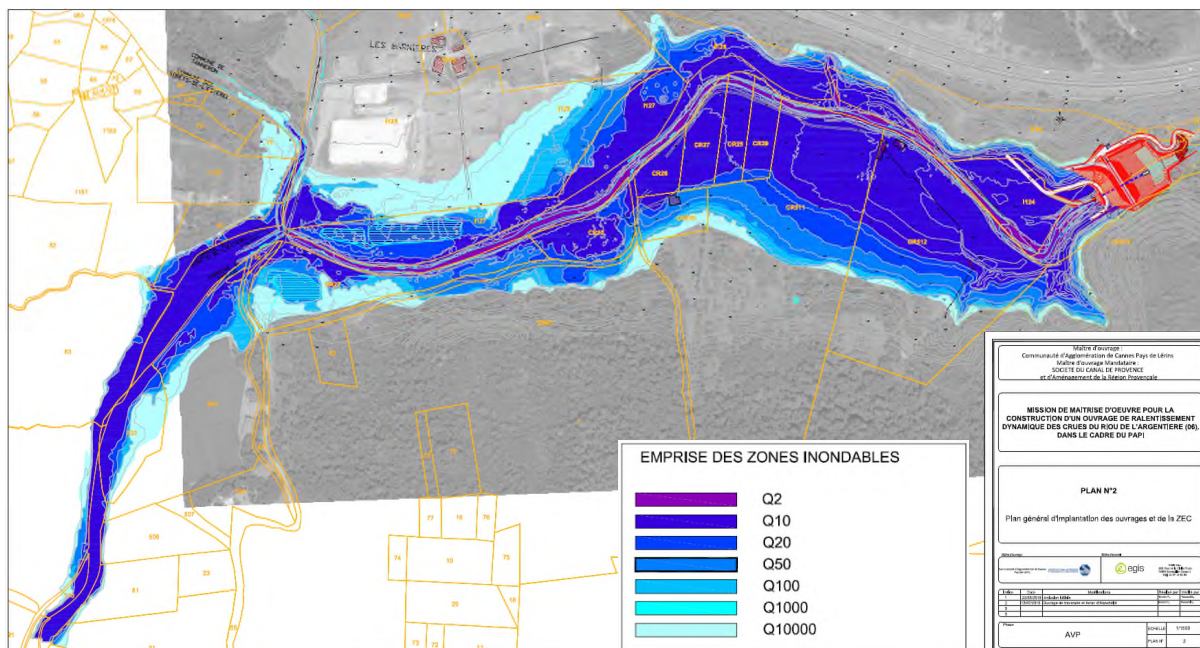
Plan d'implantation général des ouvrages et de la ZEC
